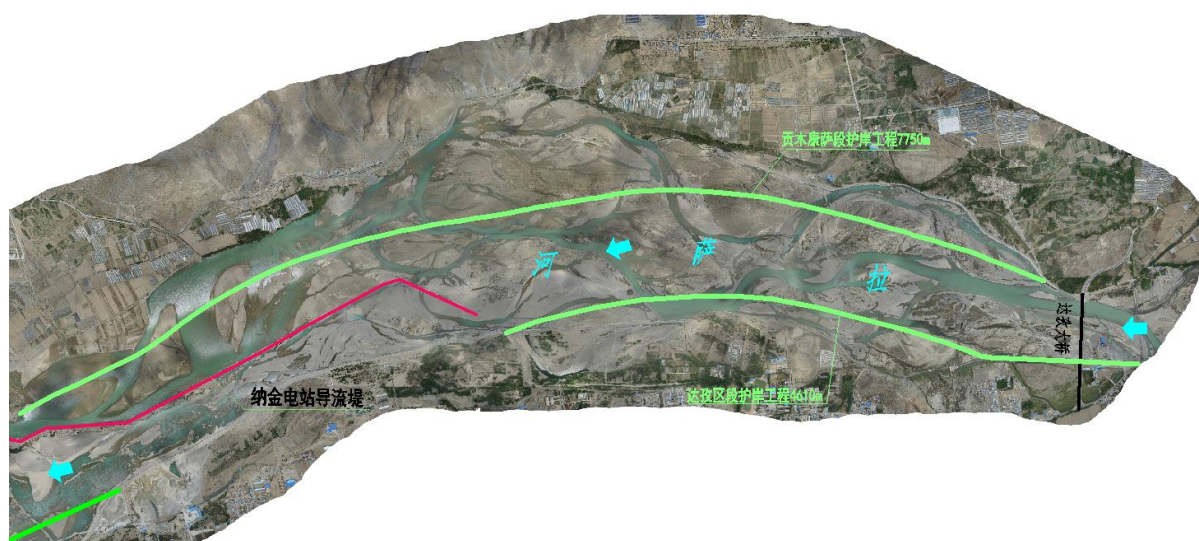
贡木康萨段与达孜区段护岸工程平面布置示意图
